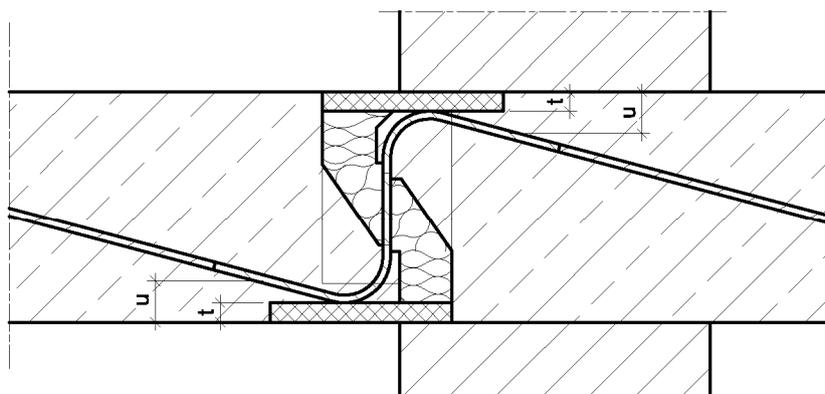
Schöck Isokorb Typ V (F30/F90)
